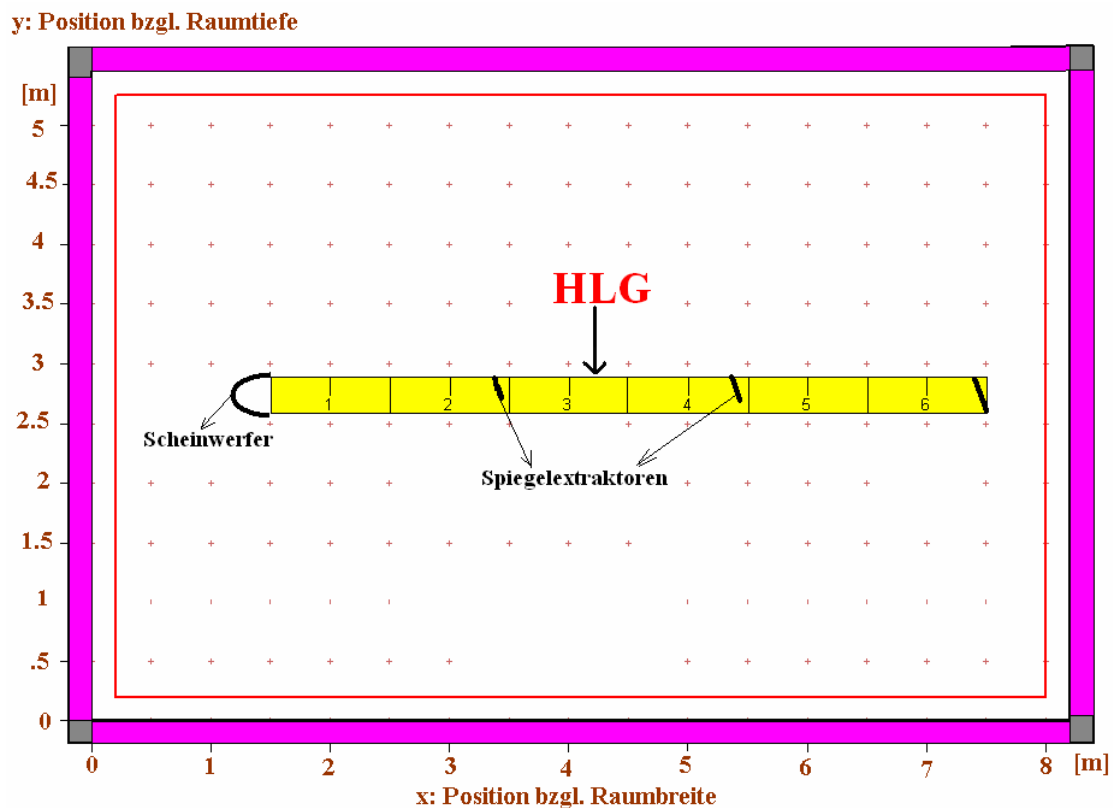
Grundriss des Spezialversuchsraums mit der Beleuchtungsanlage
